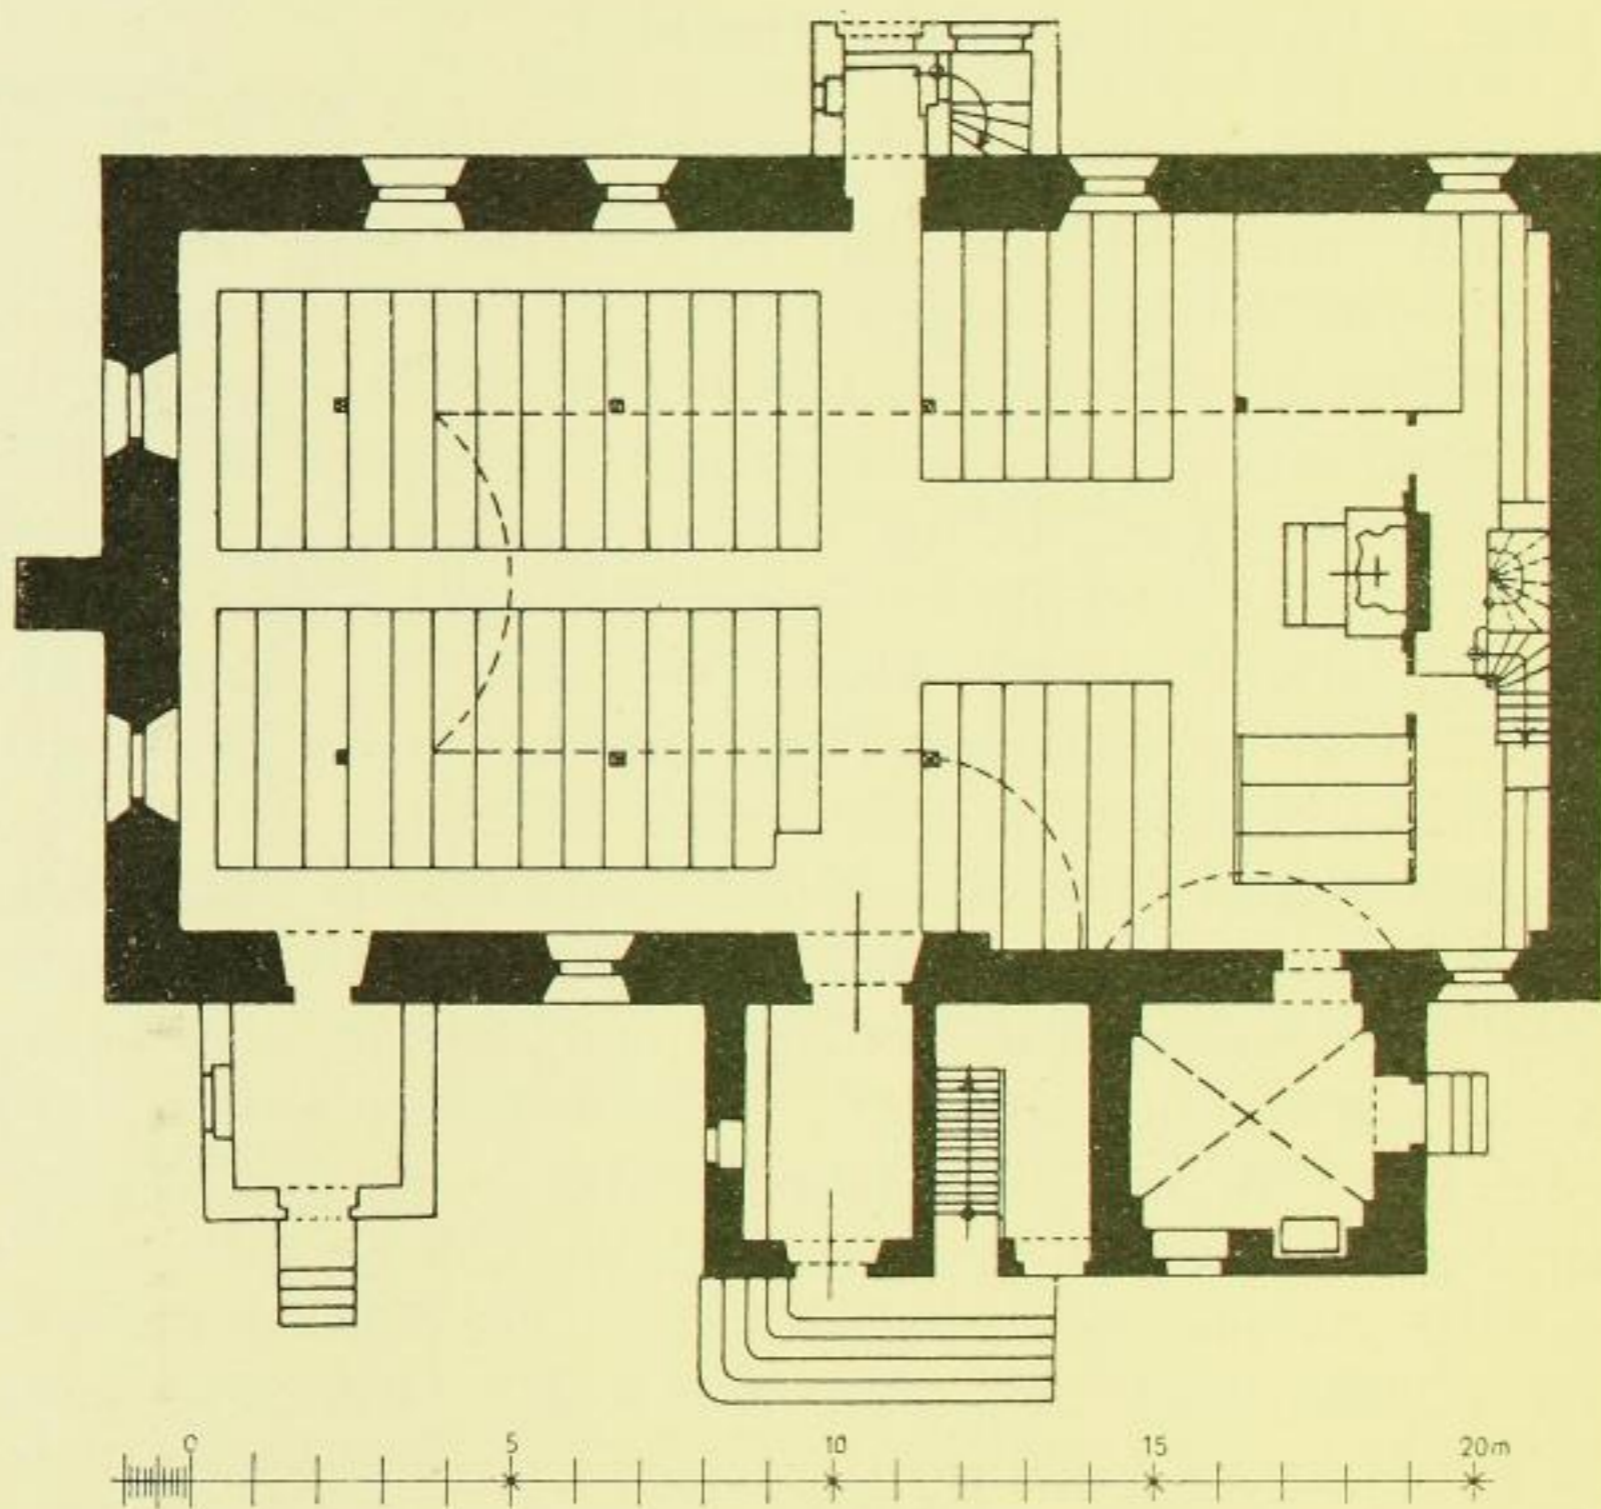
Berthelsdorf, Kirche, Grundriß.
